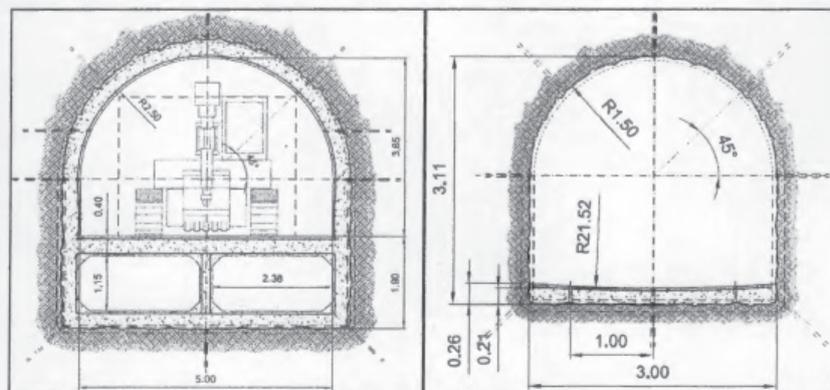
Izq.: Sección Tipo Tramo La Laguna a Vallecito – Der.: Sección Tipo Tramo Vallecito a Presa
